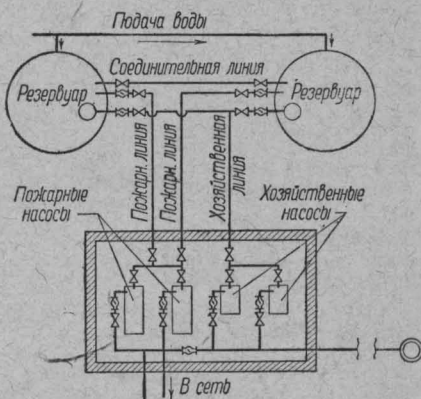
Схема узла трубопроводов у насосной станции (2-й тип).
